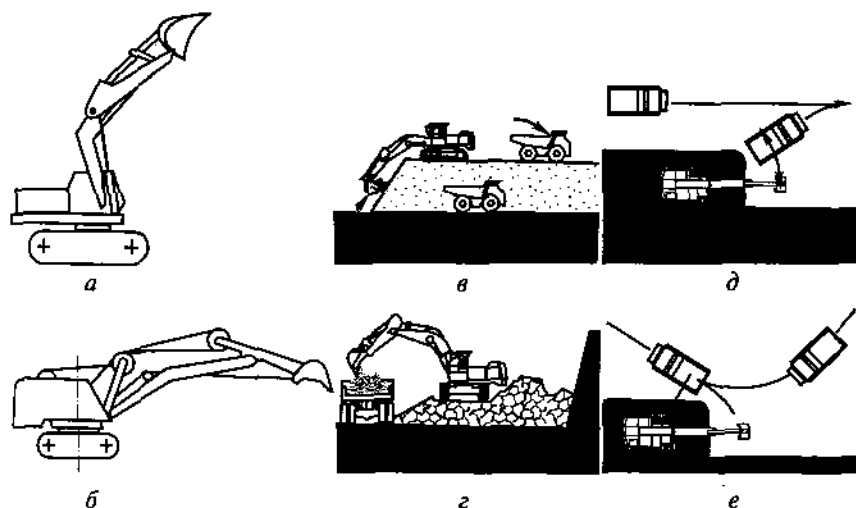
Схемы разработки грунта экскаватором, оборудованным ковшом «обратная лопата»:
